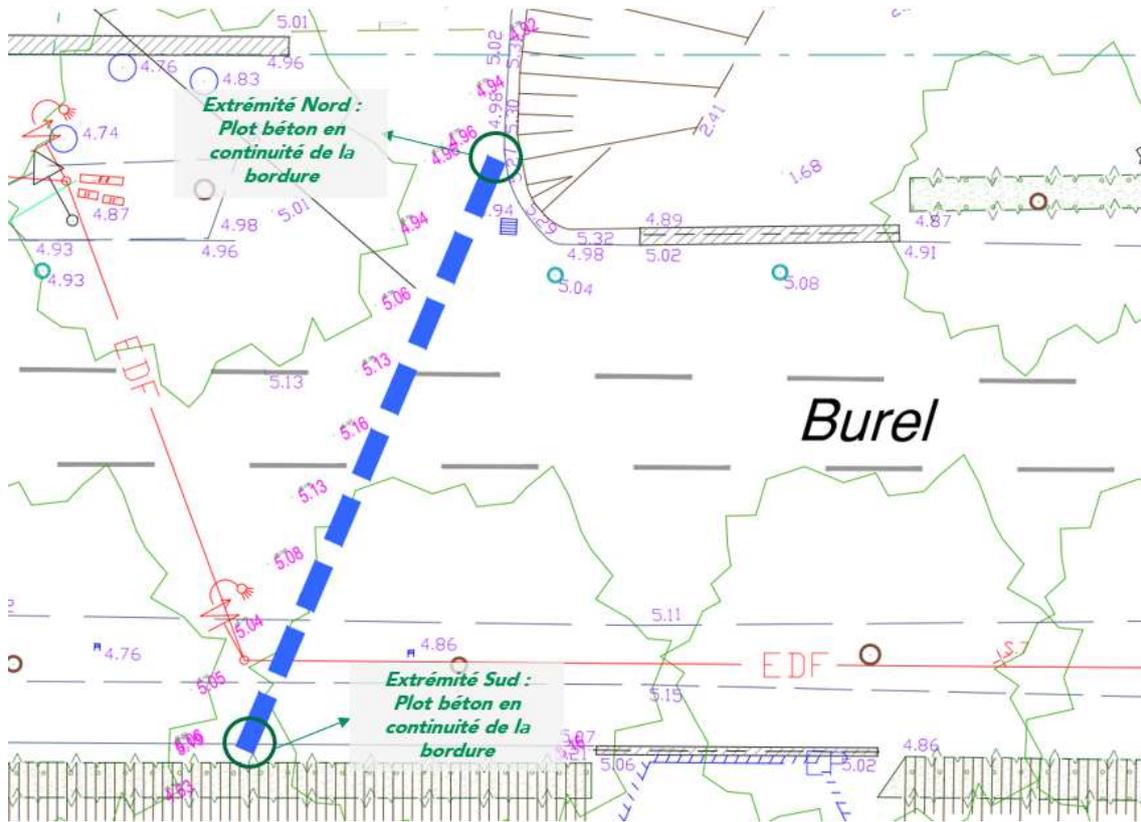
Linéaire 3 – protection amovible – vue en plan
